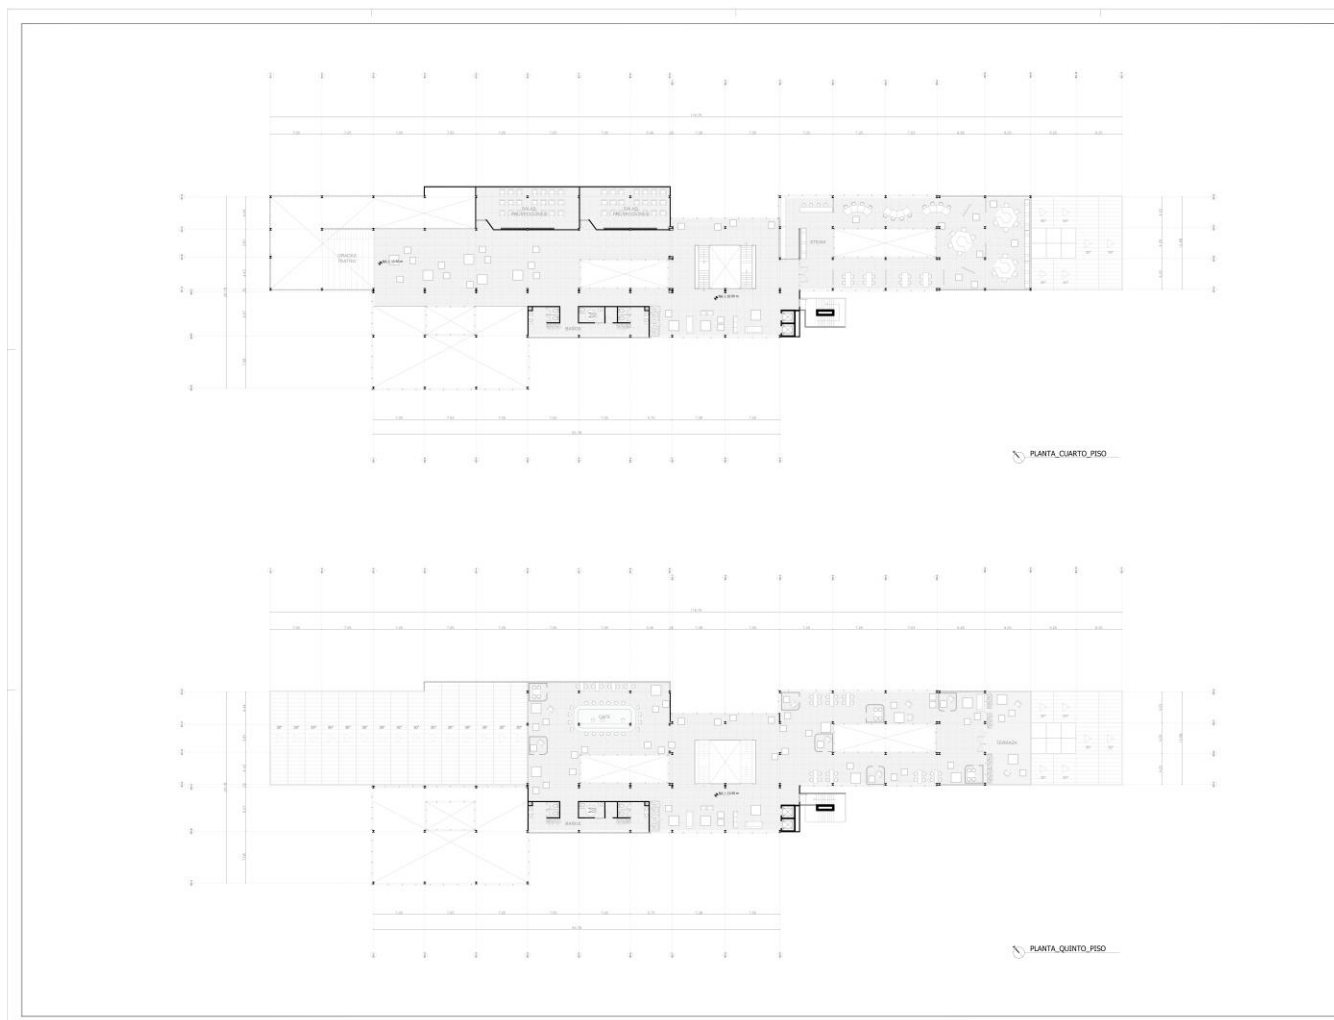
Cuarta y quinta planta. Fuente: Propia.
